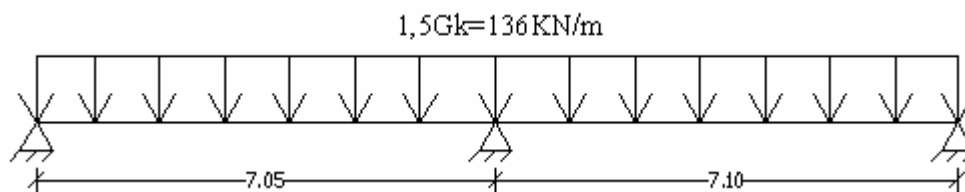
Modelo estrutural adoptado para o maciço de encabeçamento do muro de suporte
